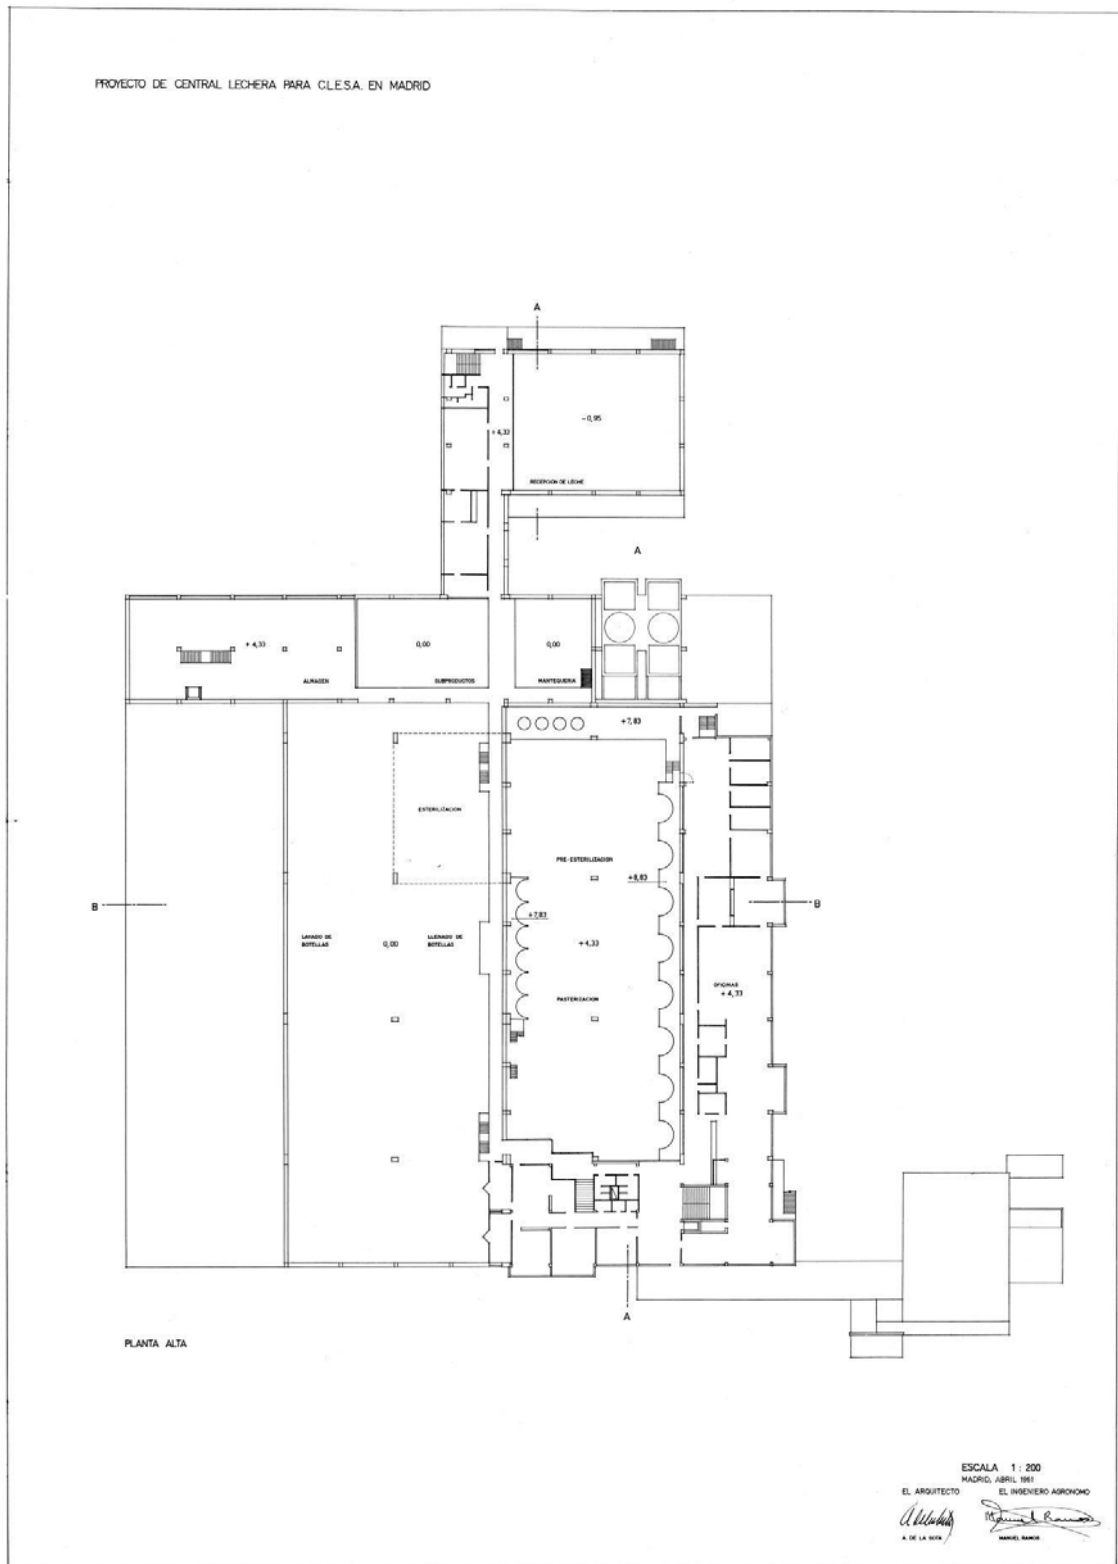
Planta alta, proyecto de 1958. COAM. Norte hacia abajo.
